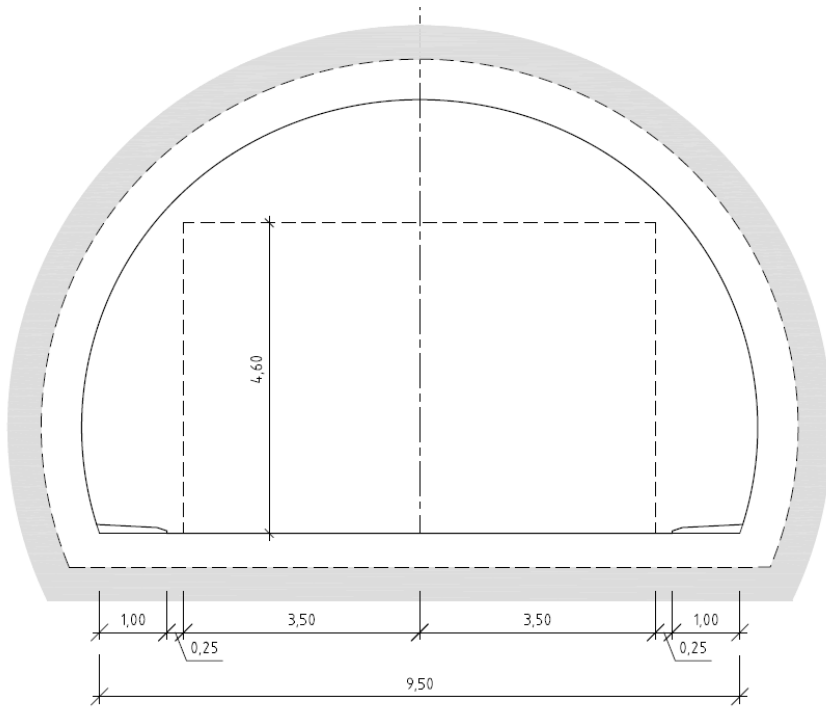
Tunnelprofil T8,5 (mål i m).
